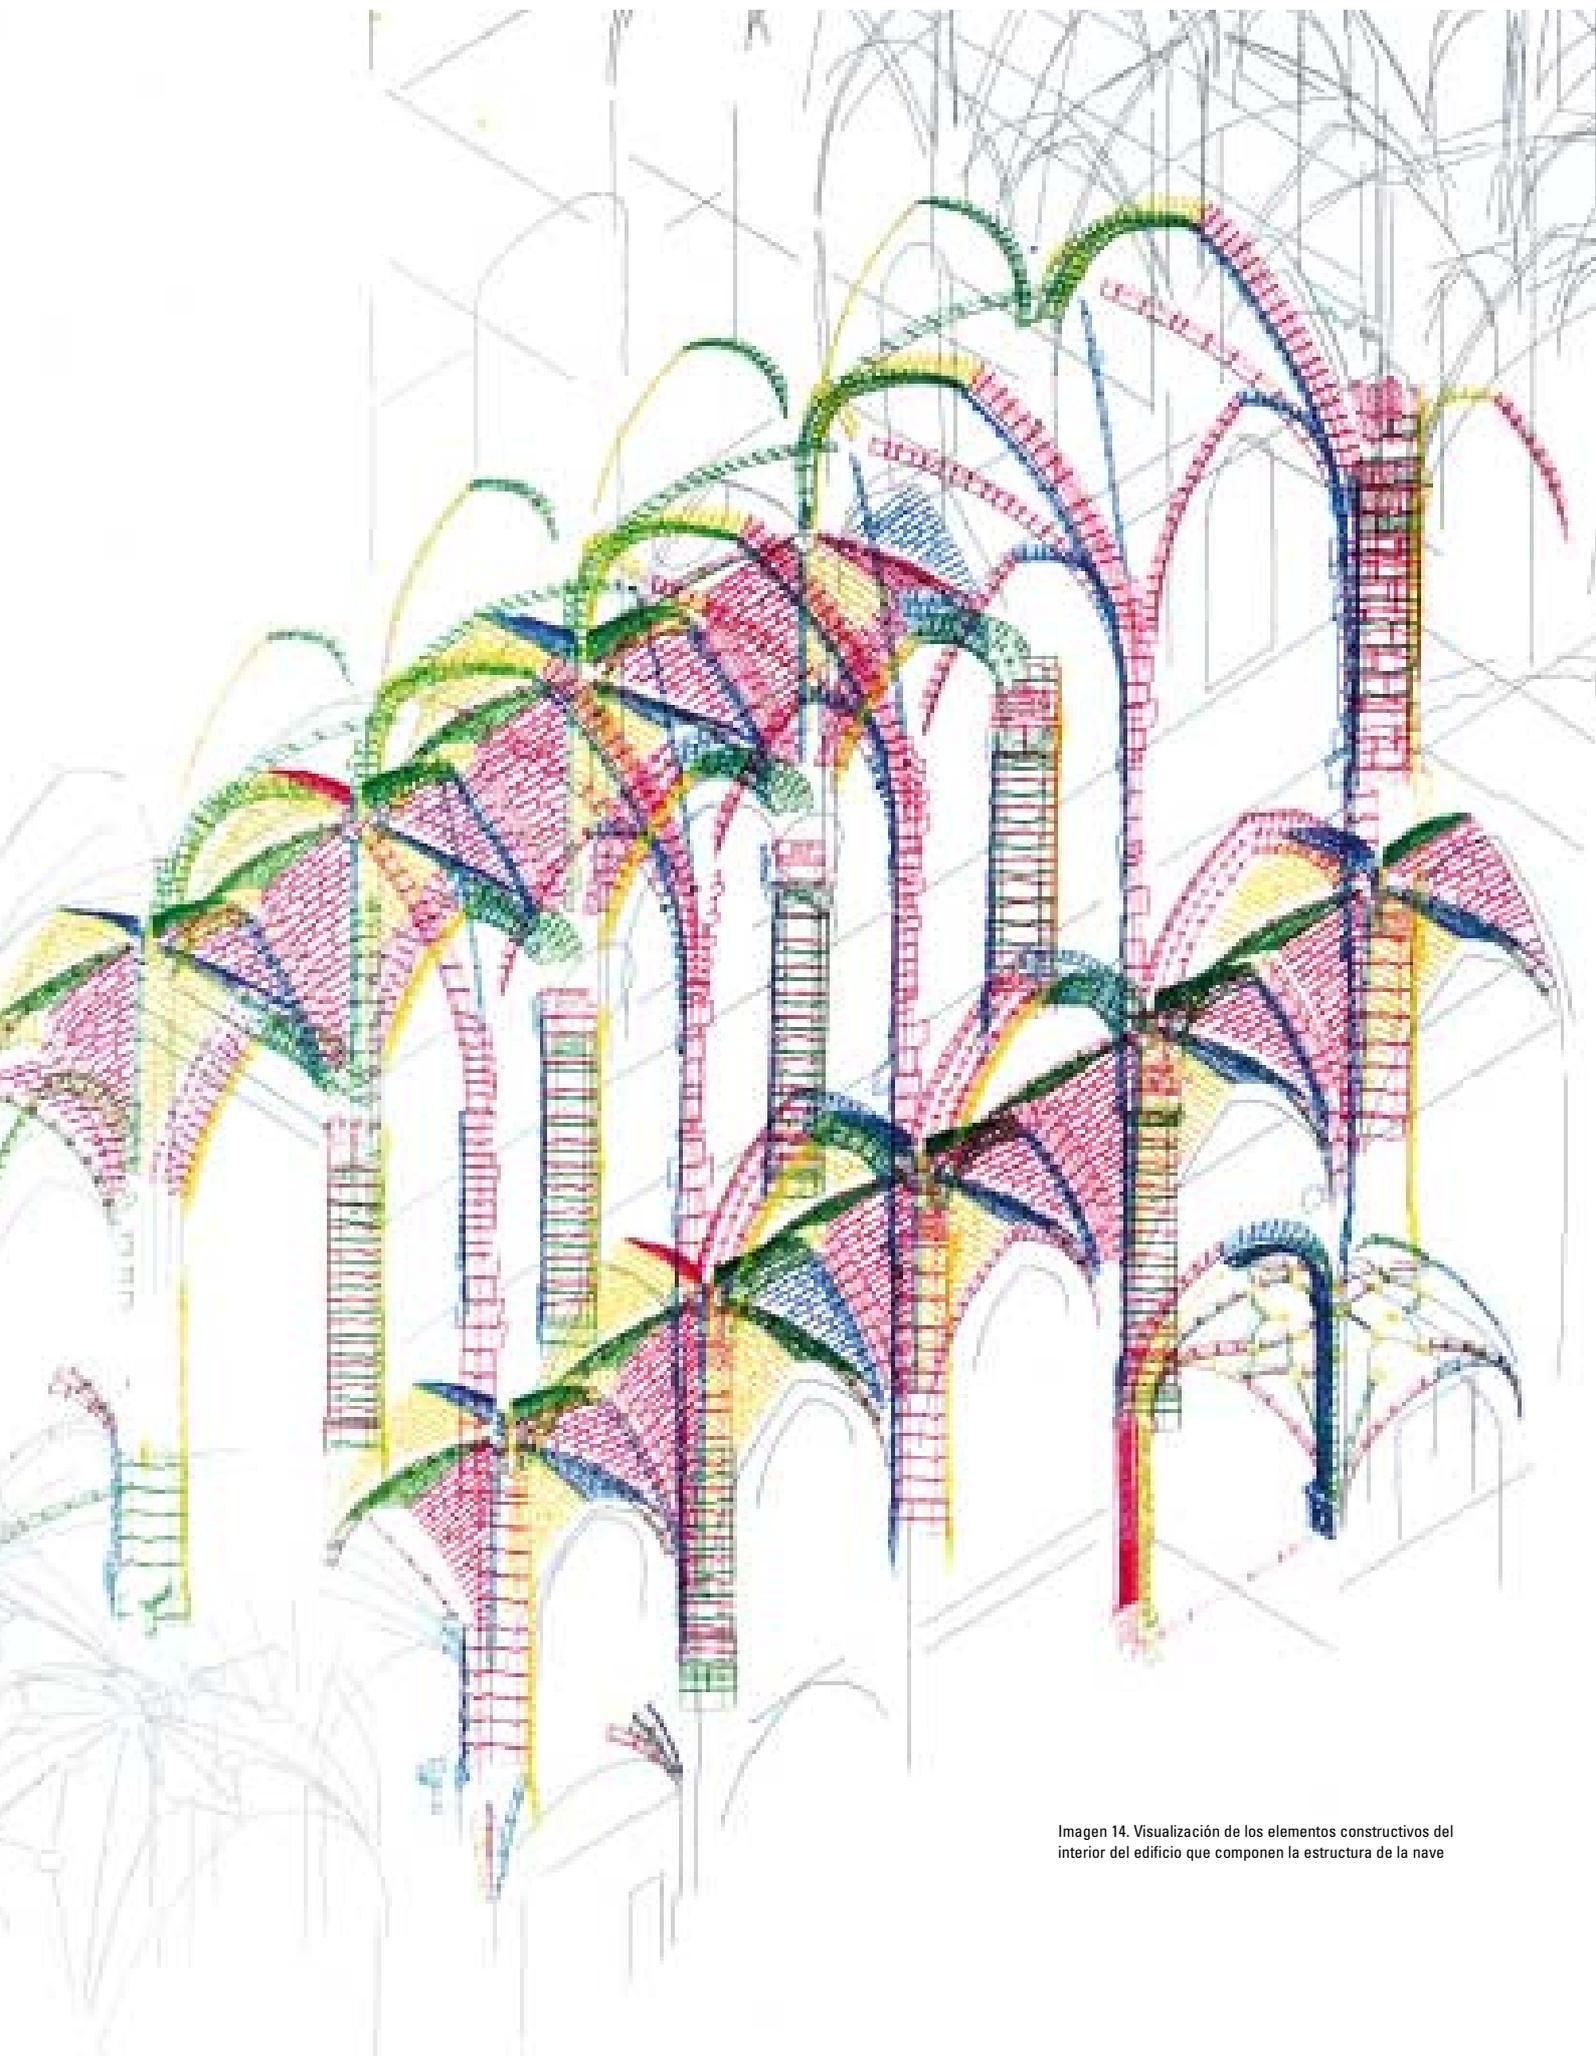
Visualización de los elementos constructivos del interior del edificio que componen la estructura de la nave
